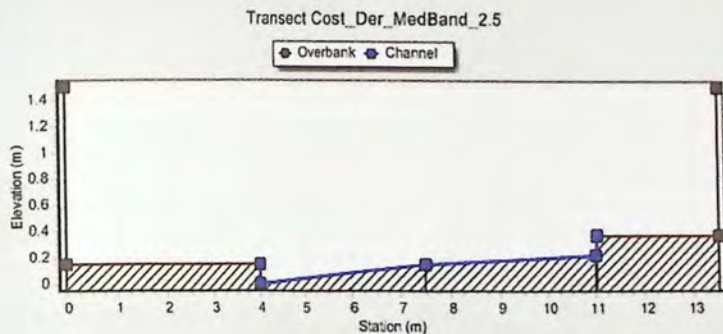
Perfil transversal calzada derecha Av. Costanera
